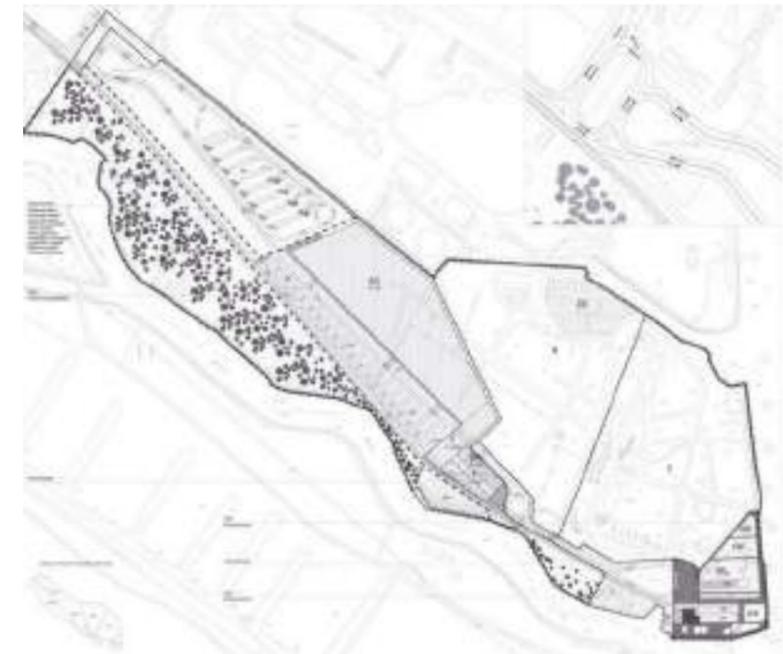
Planimetria Particolareggiato del Terminal Fusina
